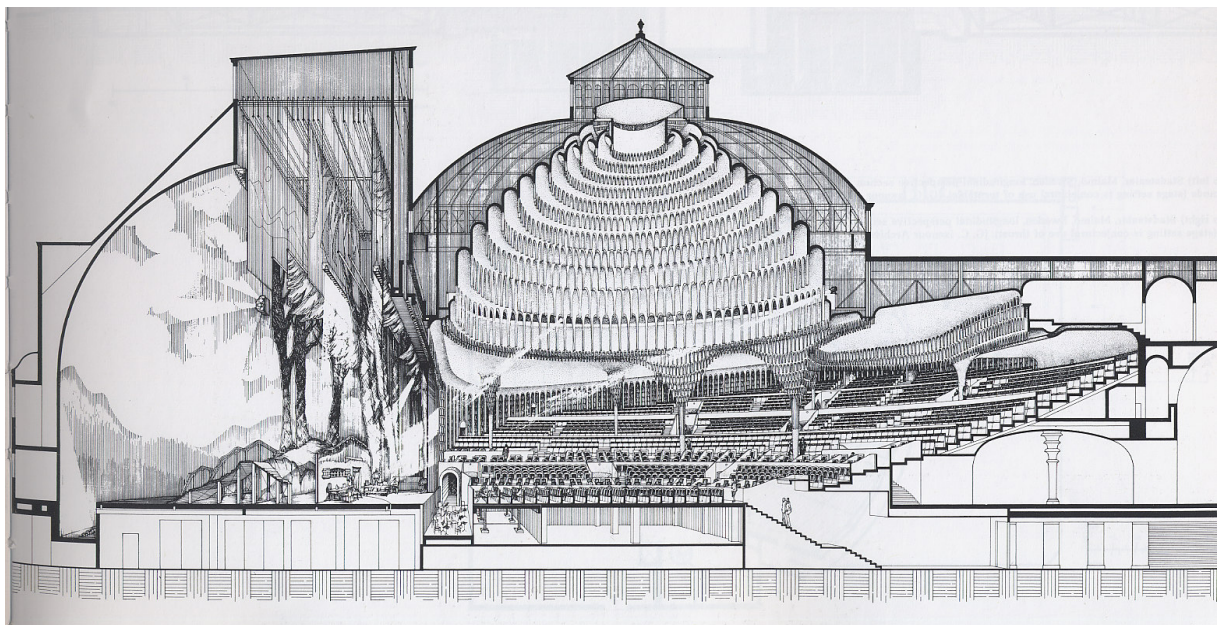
Sezione longitudinale A-A' della Grosses Schauspielhaus, disposizione con palcoscenico frontale.
